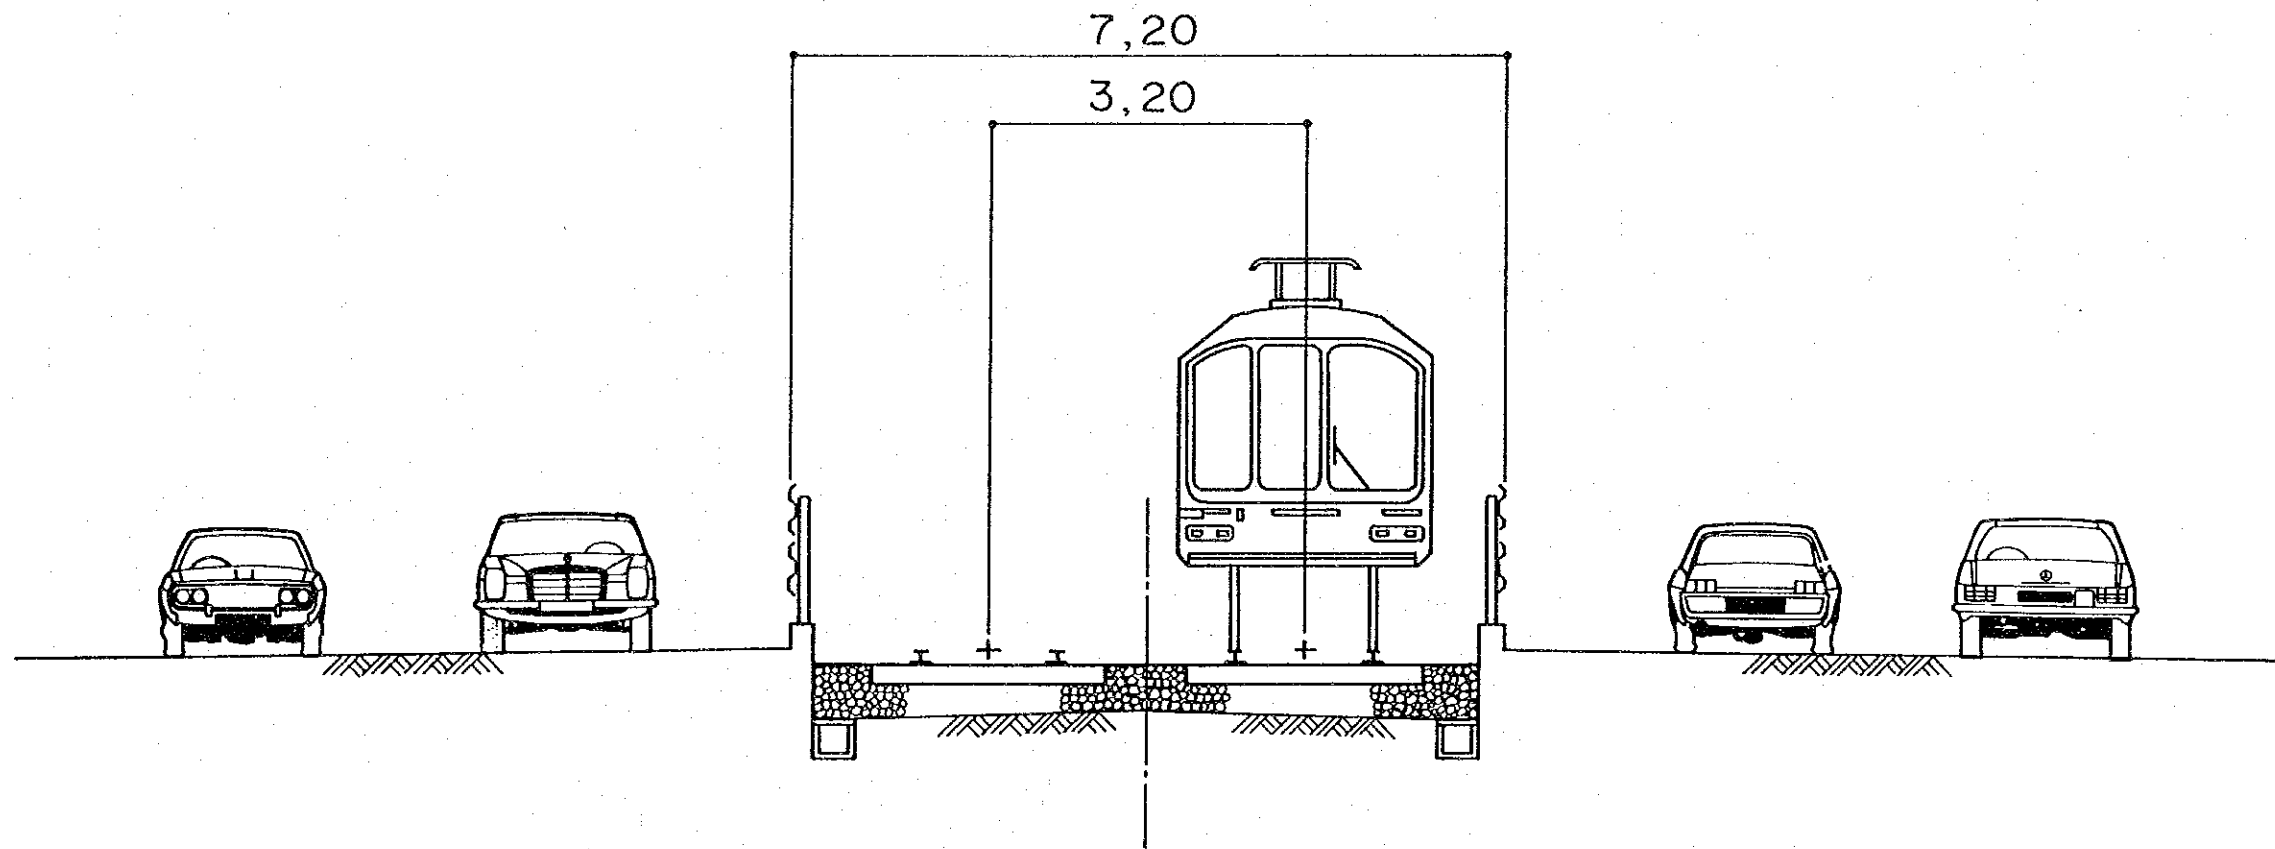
Coupe transversale de l'ouvrage au niveau du sol (chemin de fer à roues métalliques)
